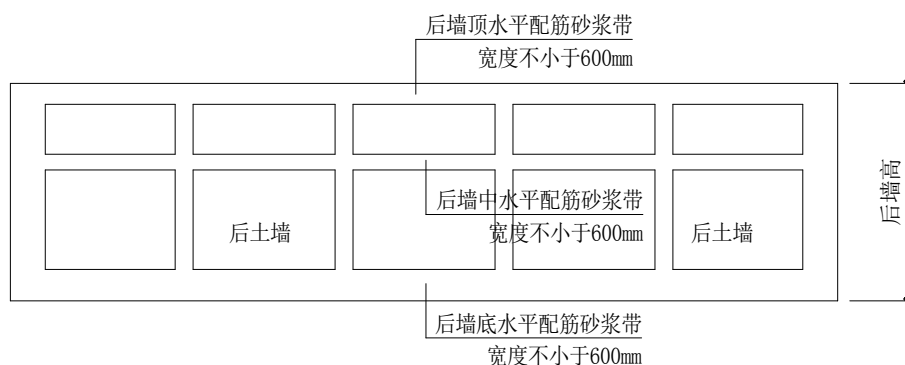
五间房后墙水平配筋砂浆带的布置示意图
